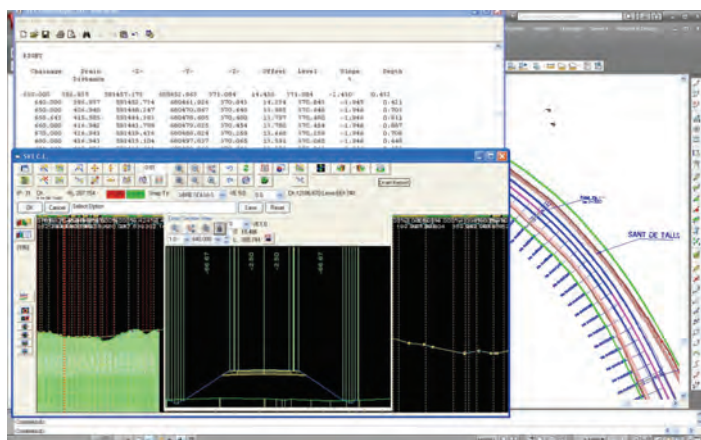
Raport text al coordonatelor de trasare a distanțelor, cotelor și pantelor profilului de șanț
